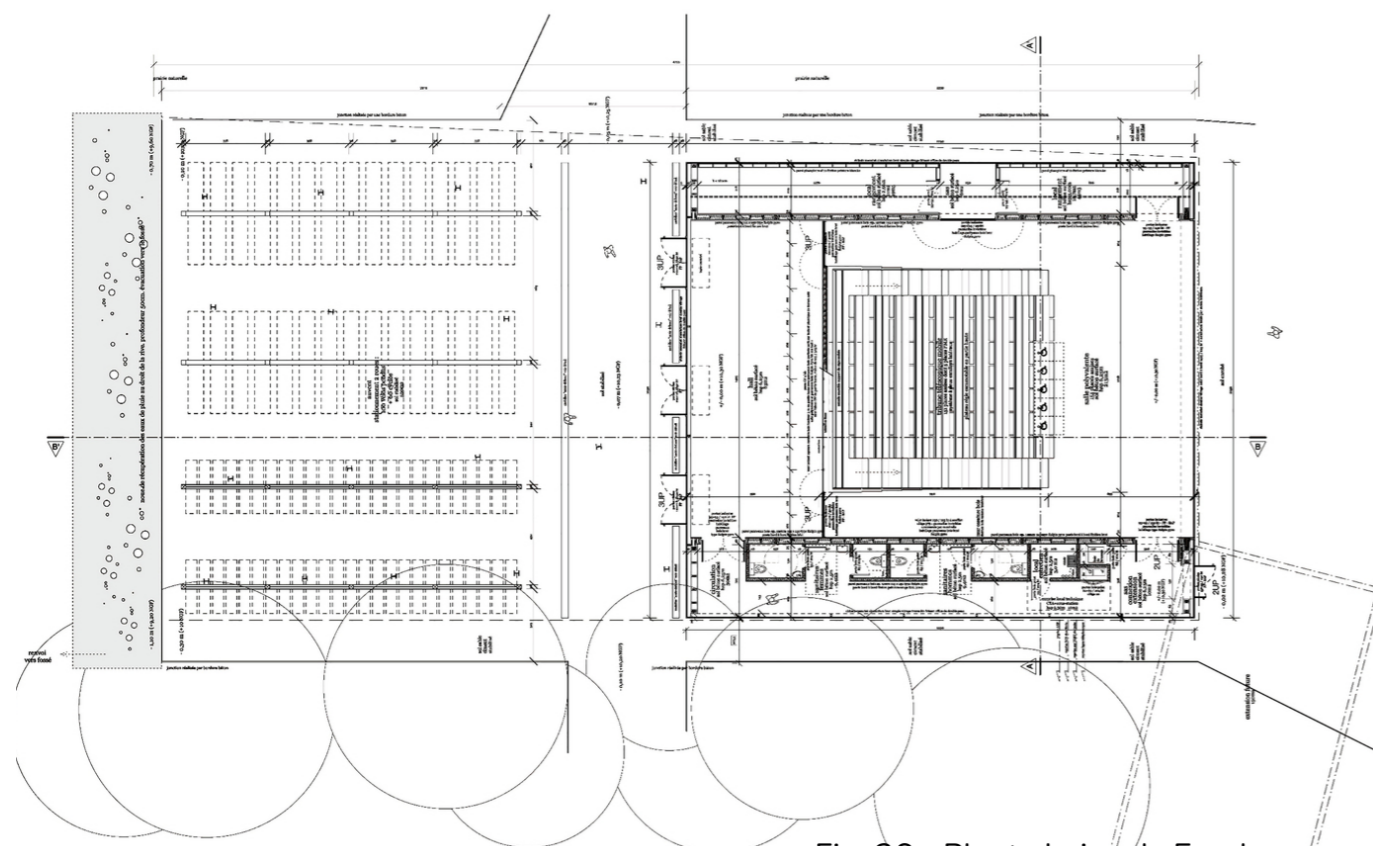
Planta baixa da Escola Secundária François Truffaut.
